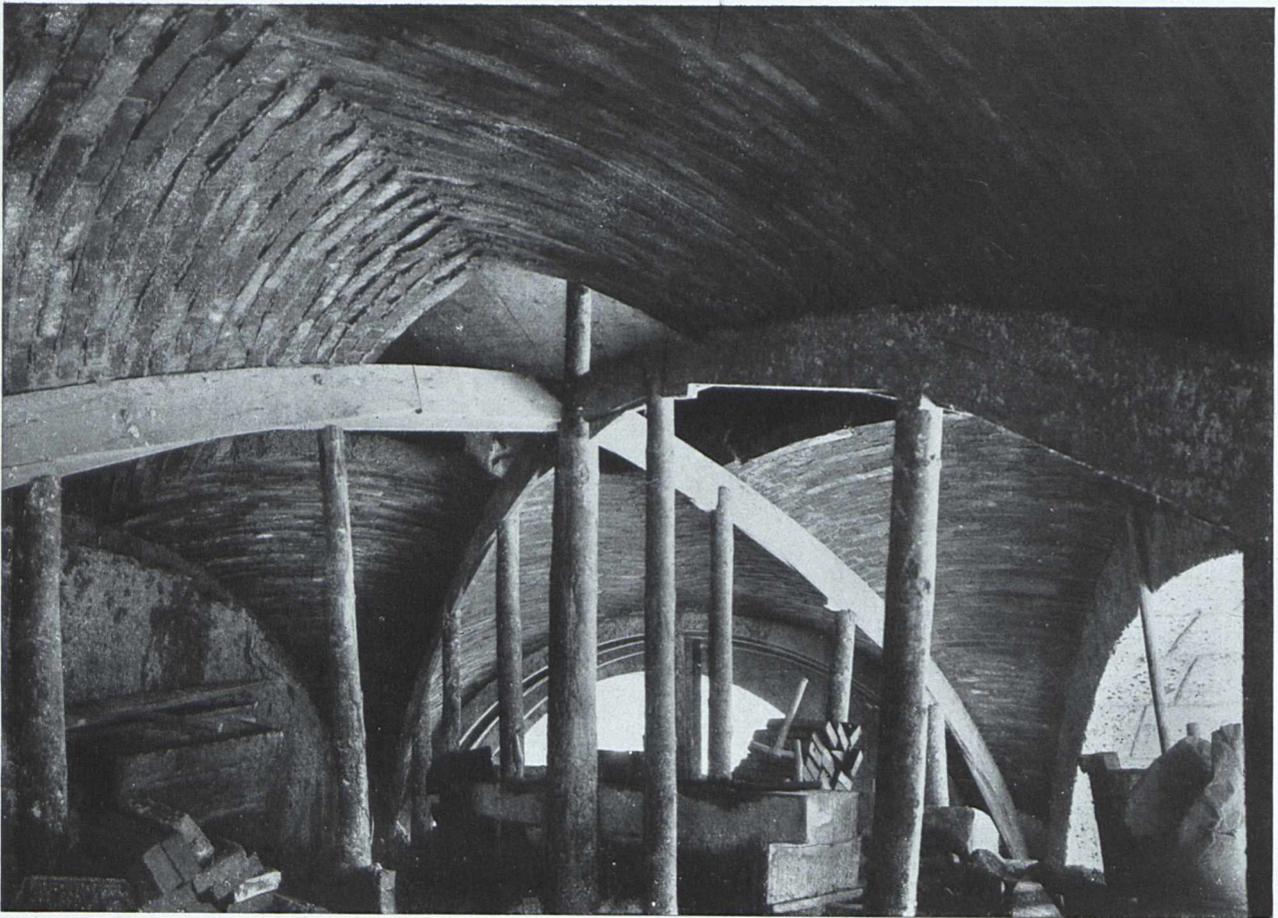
Bauausführung: Karl Stöhr, Bauunternehmung, München, Schwanthalerstraße 11
